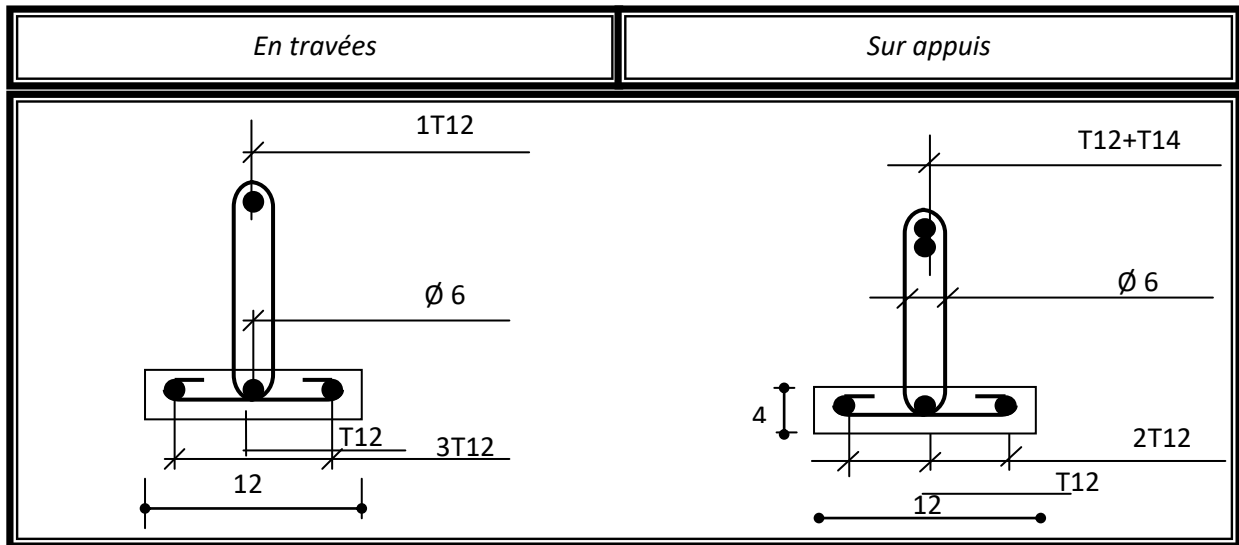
Schéma de ferrailage des poutrelles pour terrasse
